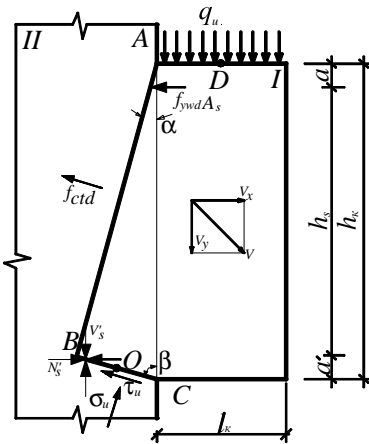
Кінематично можлива схема руйнування окремих прямокутних залізобетонних шпонок із розташуванням арматури у два яруси і враховані V_s у арматурі нижнього ярусу
